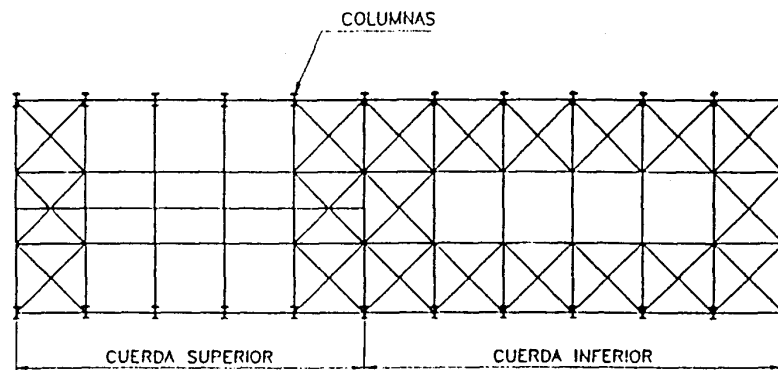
DETALLE PORTAGRUAS Y COLUMNAS
